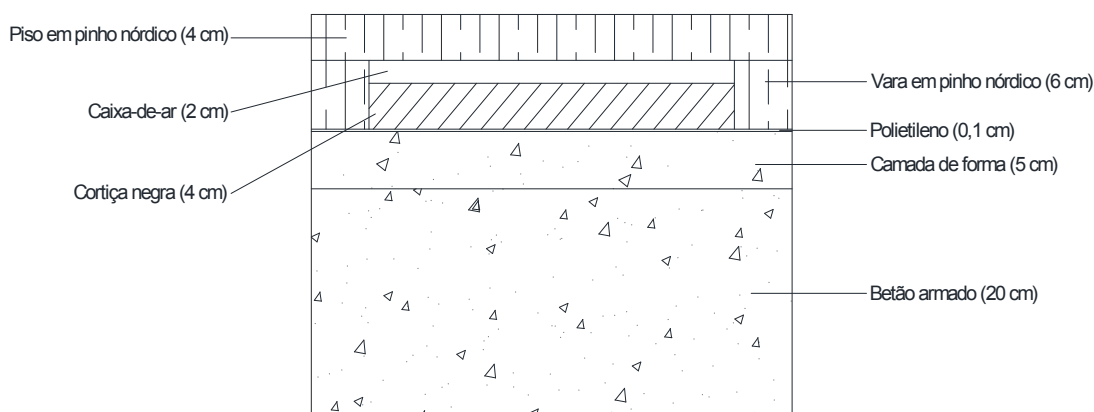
Laje de piso em betão armado e pavimento flutuante em pinho nórdico
